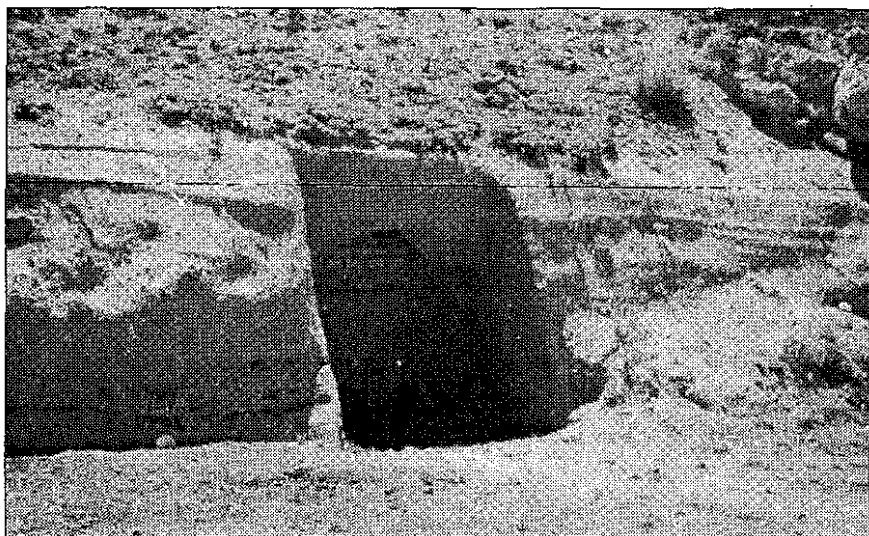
Ambar girişinde kapı türlerini beton kırıştırarak, beton siittişalarla desteklenmektedir.
